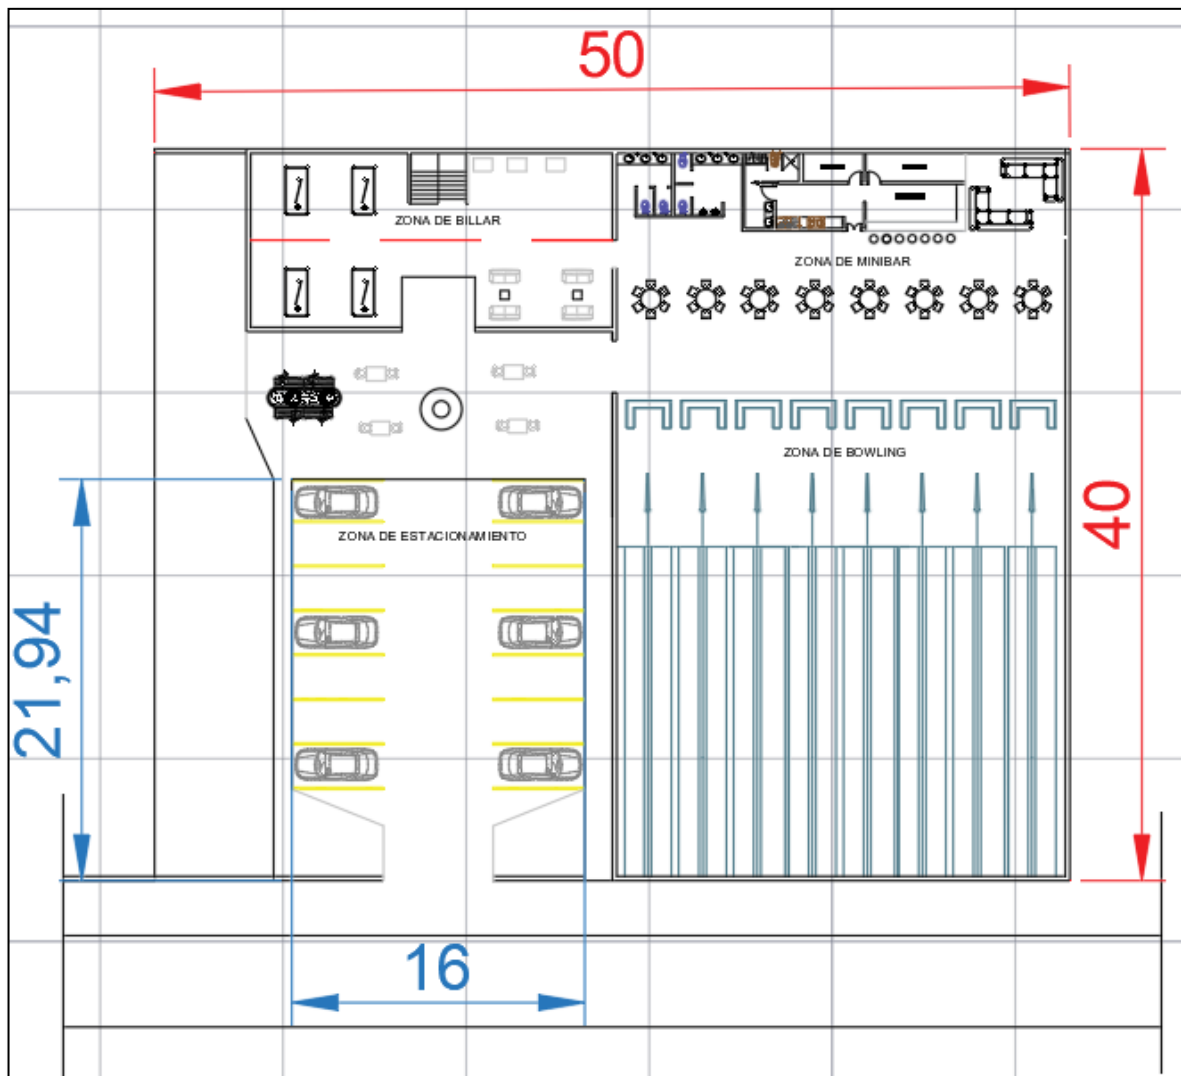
Layout del Bowling (Parte Baja) - AutoCAD
